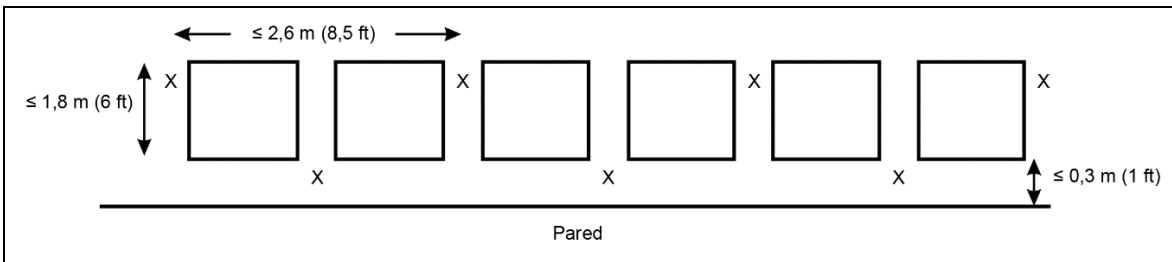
Vista en planta de una configuración alternativa de rociadores intermedios para estanterías simples con una anchura máxima de 1,8 m (6 ft) y situadas junto a la pared
